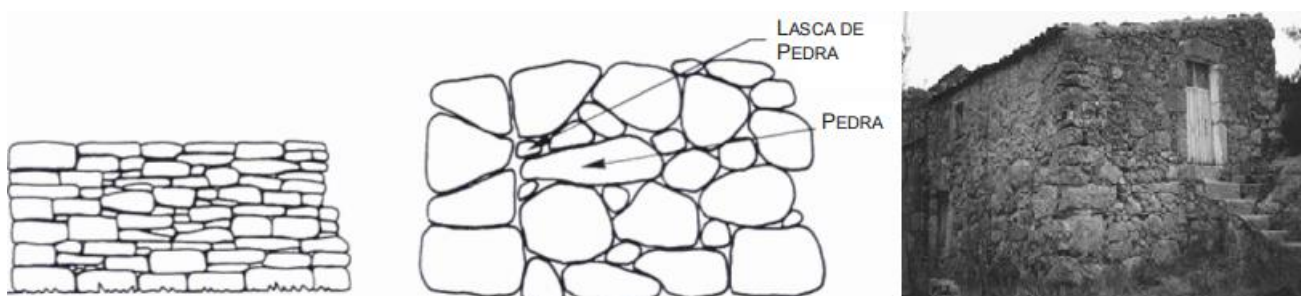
Paredes de alvenaria de pedra com junta seca (A. De, 2010) & (Ir et al., n.d.)
